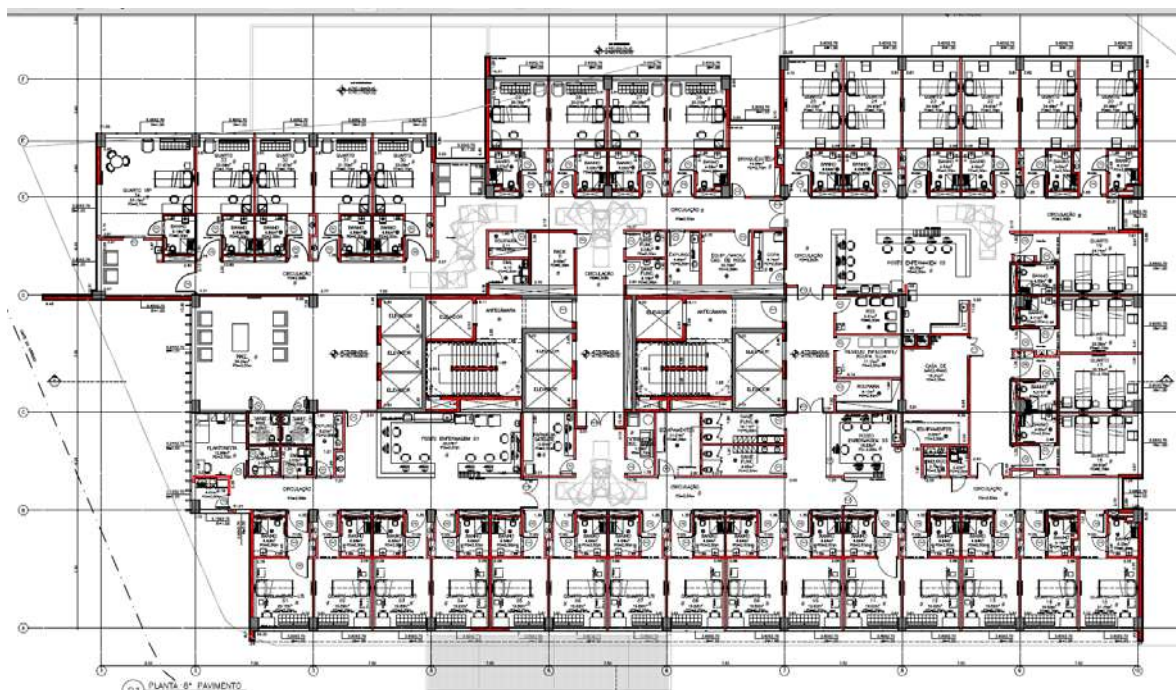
Planta 8º Pavimento – Leitos e UTI – Pediatria.
